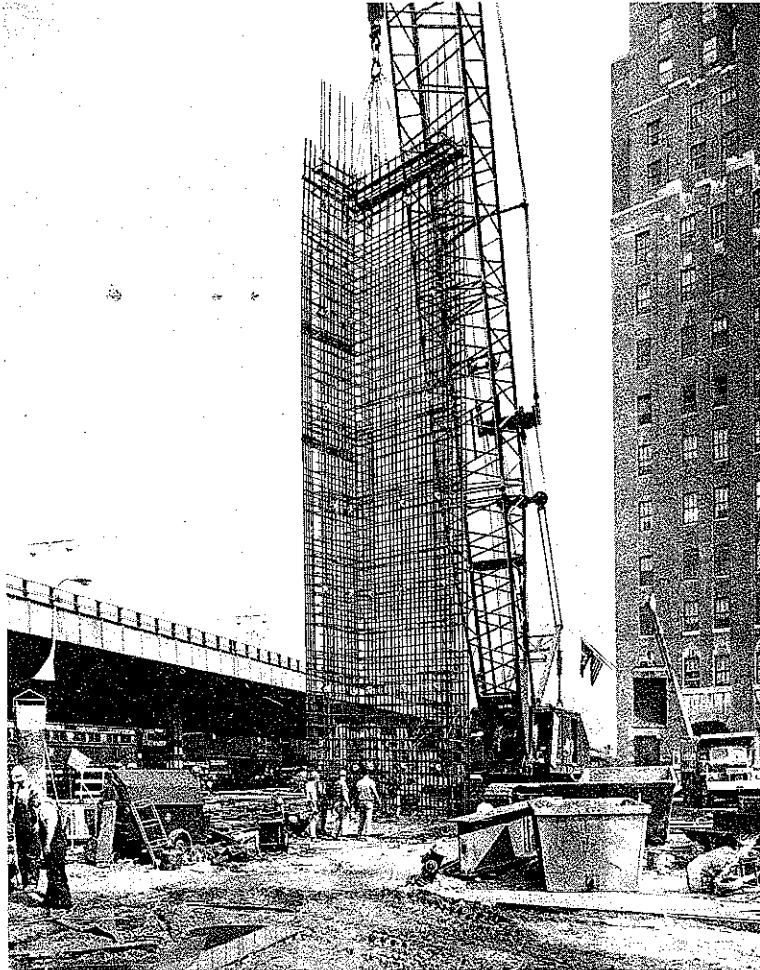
a. — Mise en place par Icos d'un ferrailage préfabriqué de 23 m de long pesant 25 t, à l'un des angles de la paroi moulée ceinturant le World Trade Center à New York.
